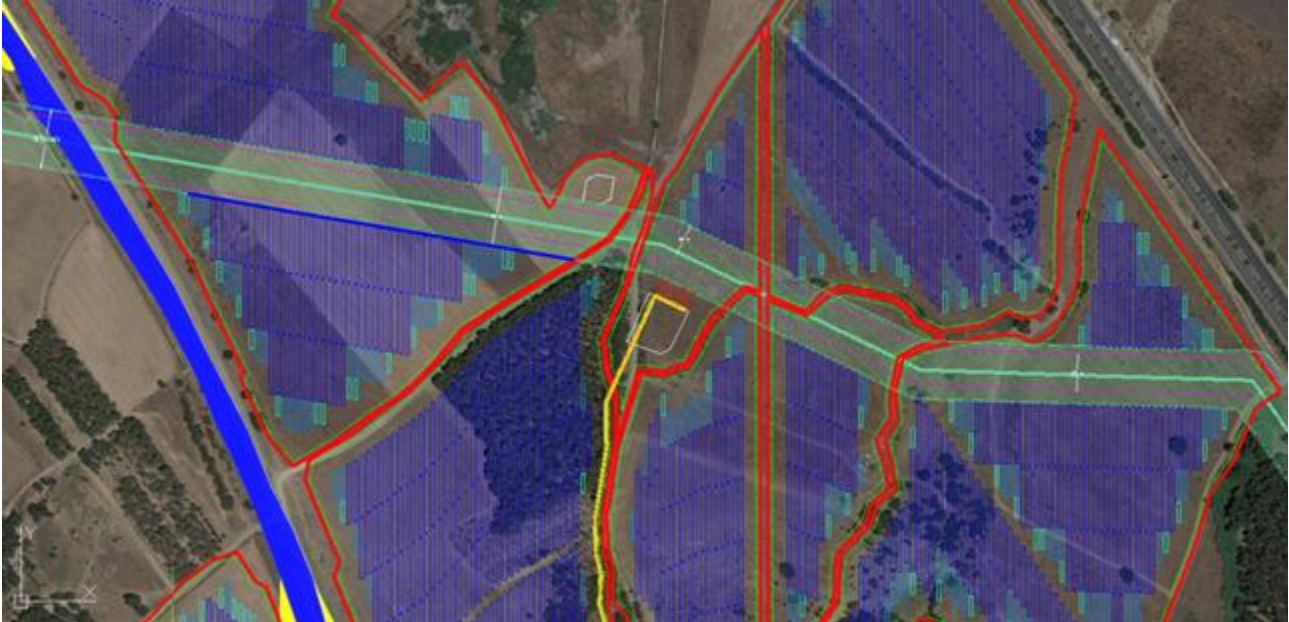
dettaglio layout Lotto C rispetto al metanodotto Cagliari-Palmas Arborea
